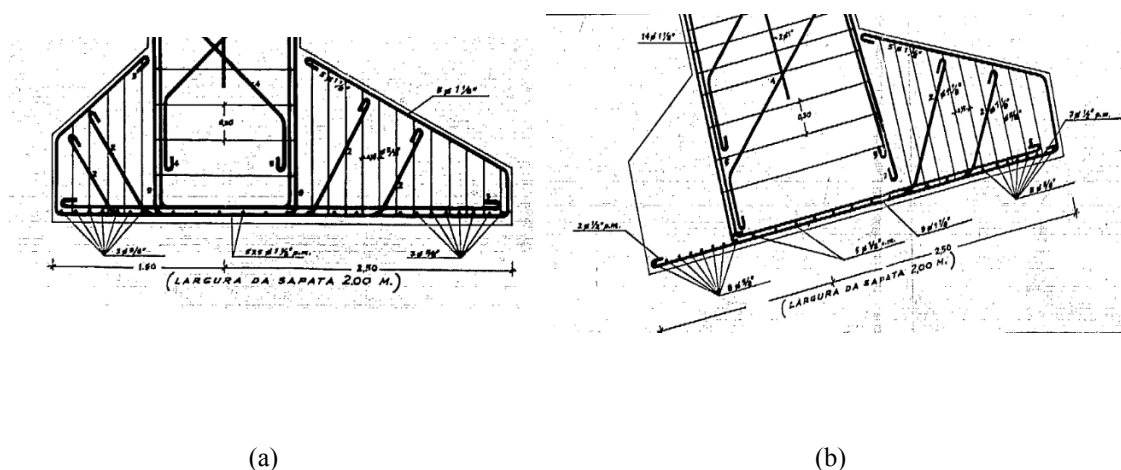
Pormenor da disposição das armaduras (a) sapata interior (b) sapata exterior
